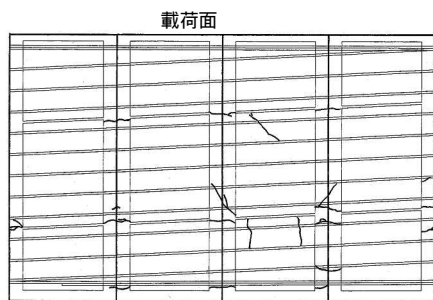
ひび割れ発生状況 (AP 3)
